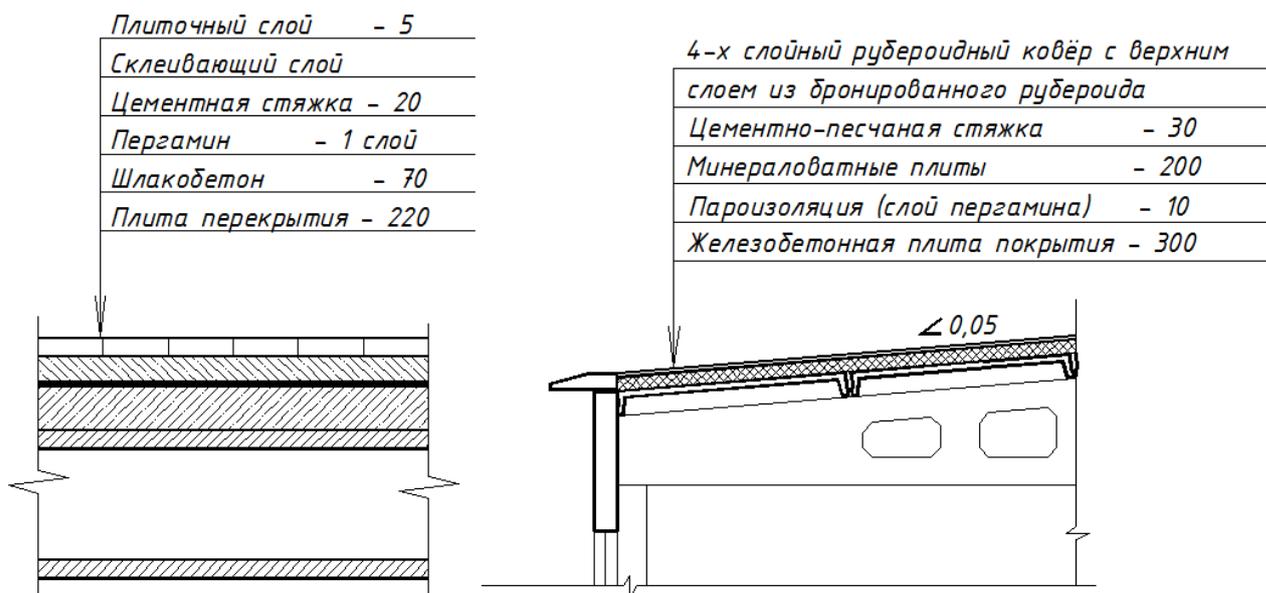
Примеры выполнения выносных надписей к многослойным конструкциям а) конструкция пола на перекрытии жилого дома;
